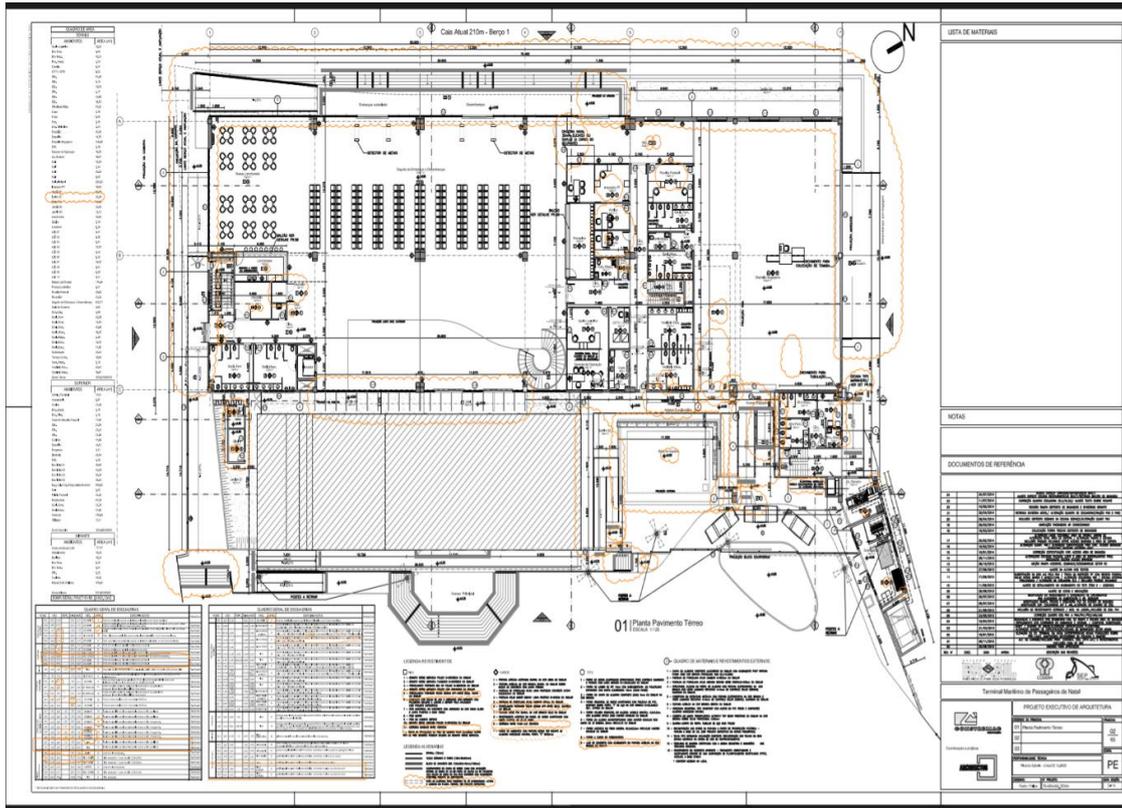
Planta andar térreo do Terminal Marítimo de Passageiros
